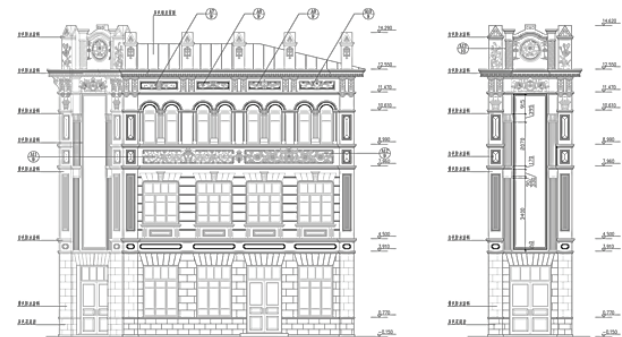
Фасад правого крыла. Пятый (угловой) фасад
